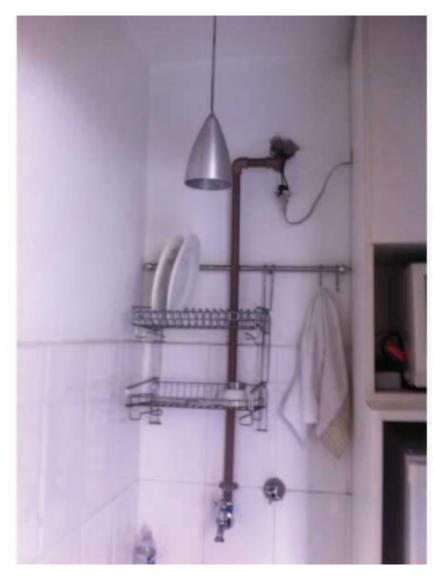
Detalhe do escorredor de louças, tendo tubulação aparente ao fundo, bem como fiação onde estão conectados o micro-ondas e a geladeira.
